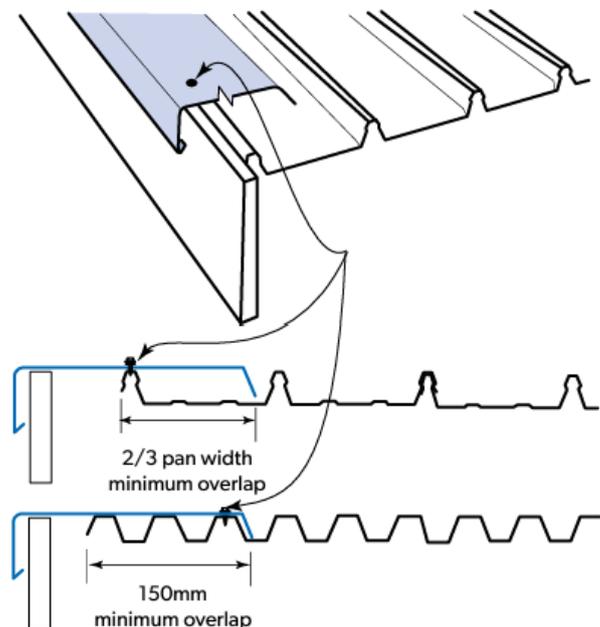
Sobreposição mínima recomendada para *flashings* longitudinais (Fonte: HB39-2015)
